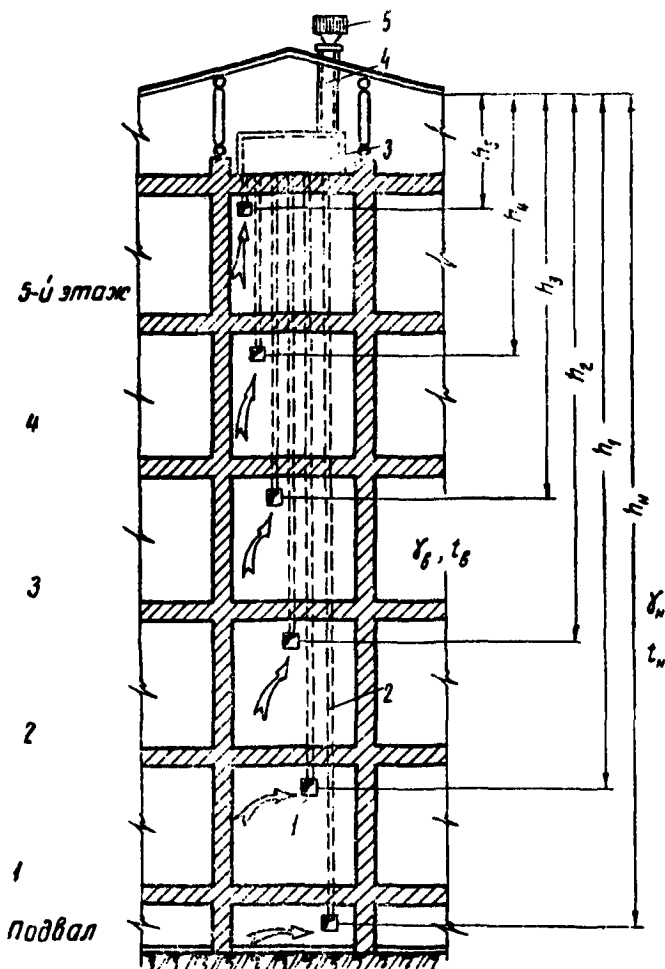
Схема естественной вентиляции помещений 5-этажного дома под действием теплового напора:
